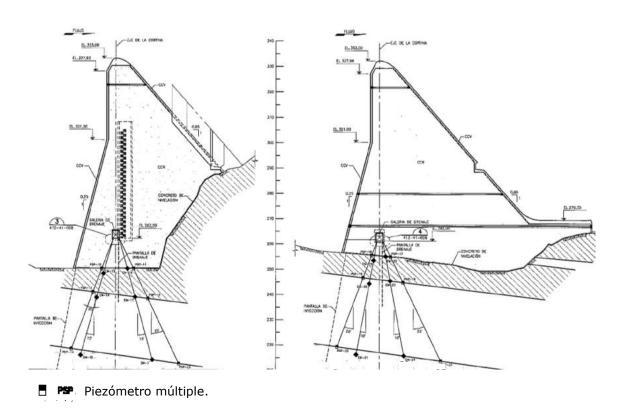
IV.3.3 Vista de la ubicación de los piezómetros múltiples en la zona de galería de la presa sección D (bloque 7) y sección E (bloque 9).
